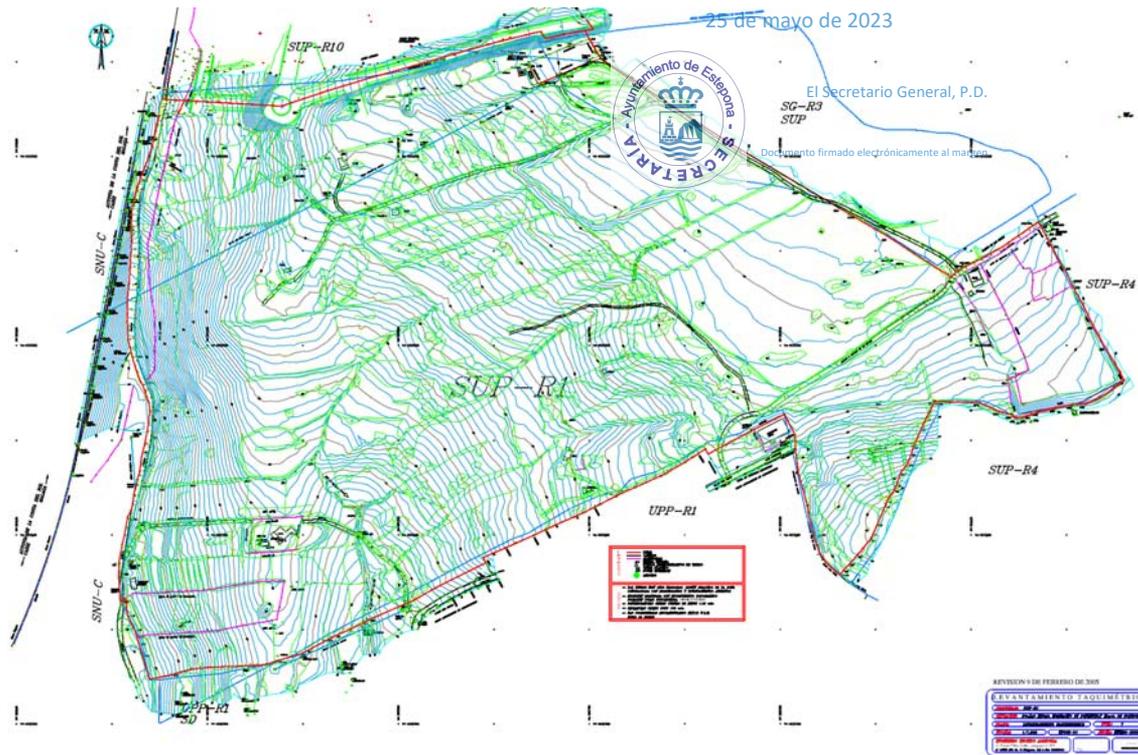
Plano de planta topográfica de la zona de estudio.
